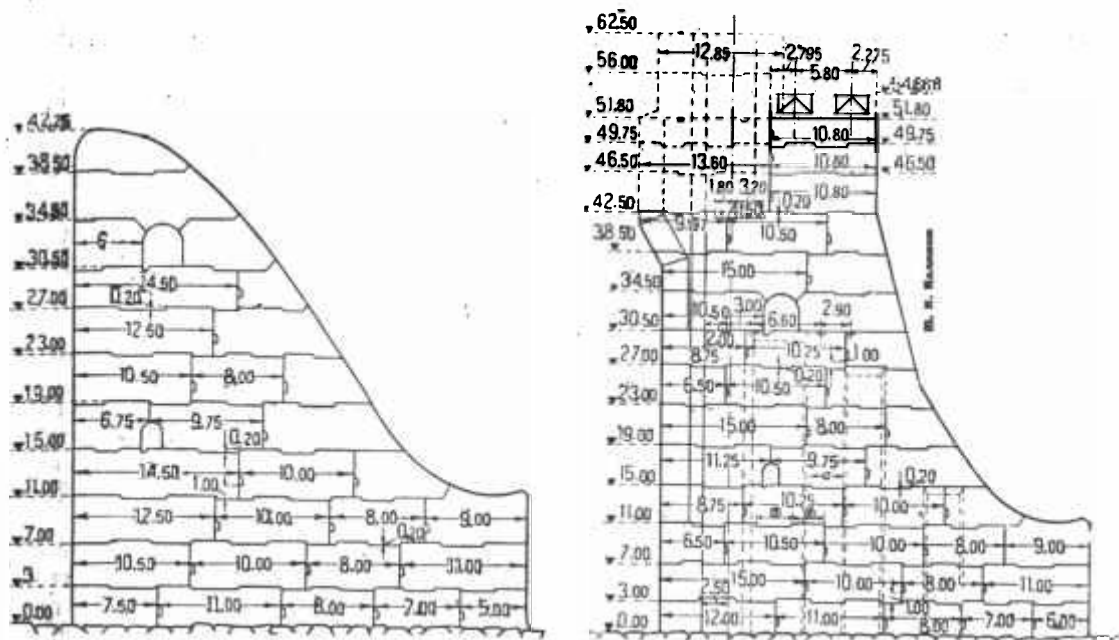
Типовая разрезка бетонной кладки бычка плотины и водосливных пролетов между бычками.
